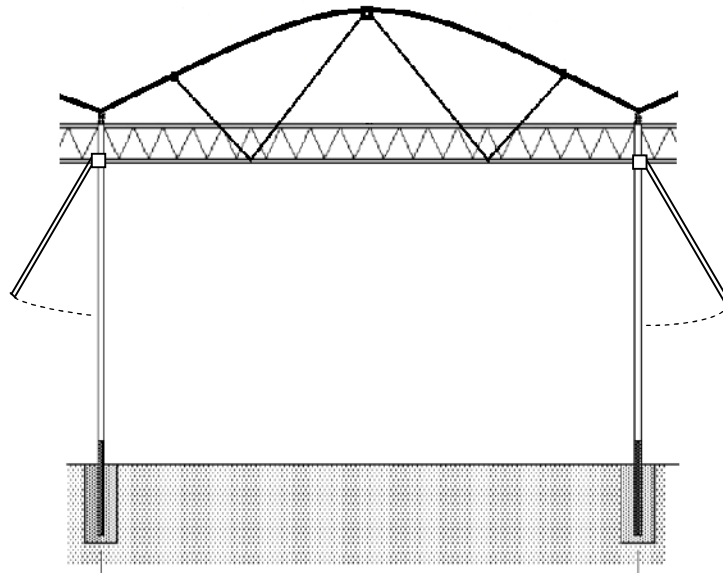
Struttura altre serre - modulo profilati di alluminio a tunnel - .
